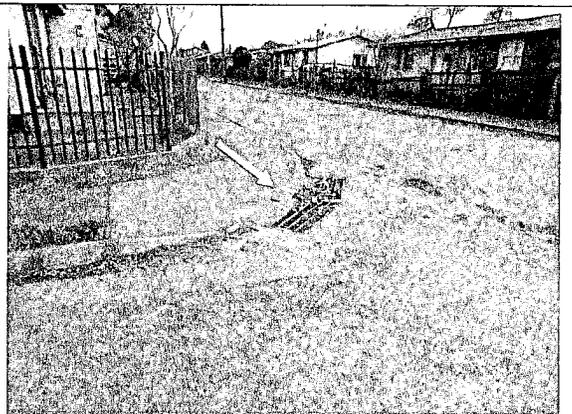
DISPOSITIVO DE RODADO SOBRE SUMIDERO
